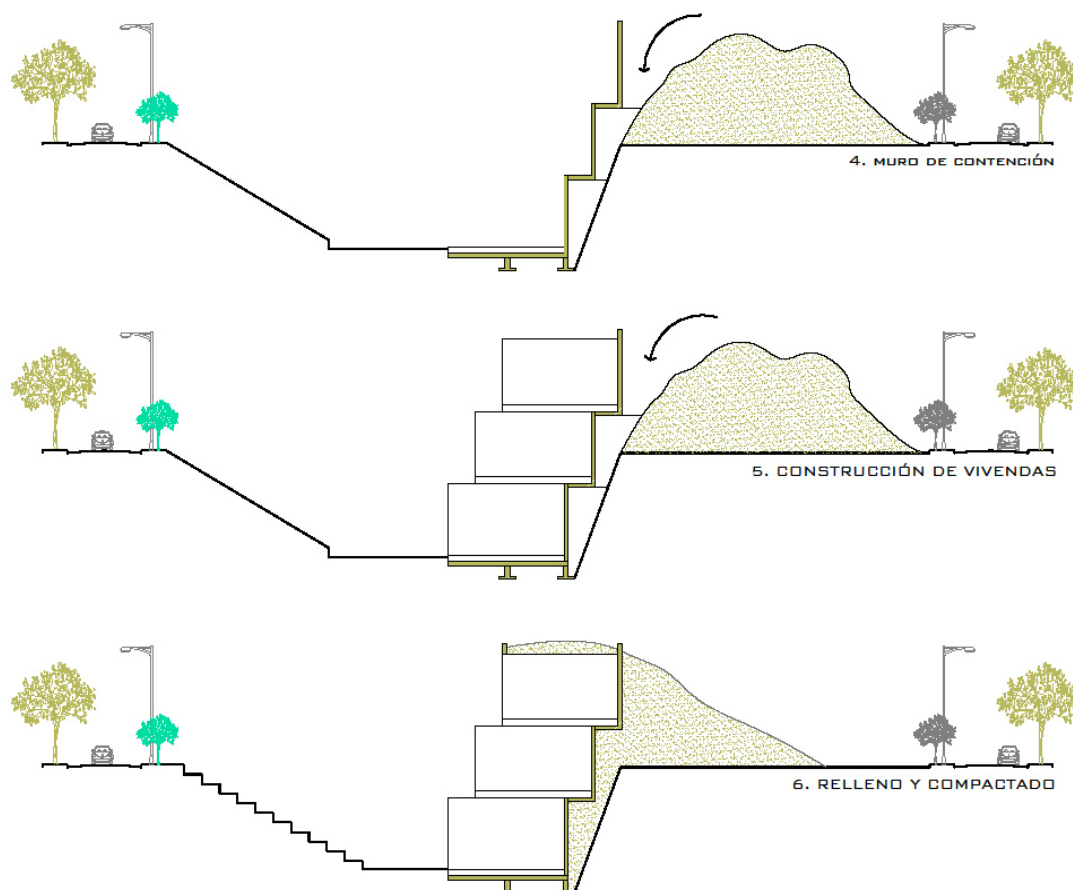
Sistema constructivo de los BPU. Fuente: Elaboración propia.
